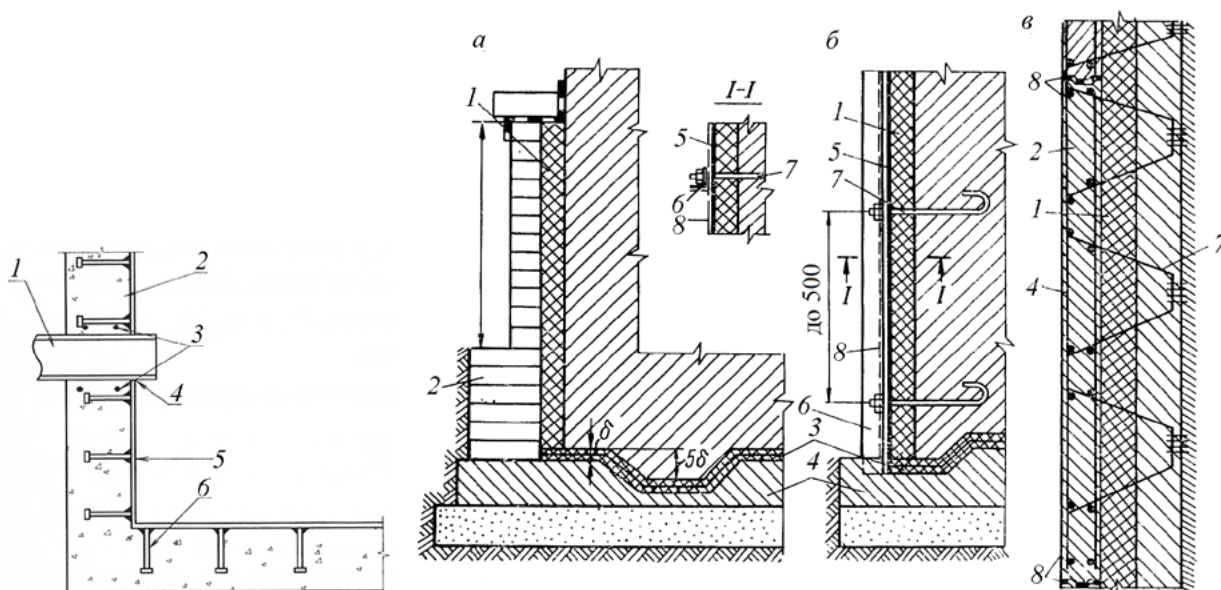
Конструкции литой асфальтовой гидроизоляции на стенах:
